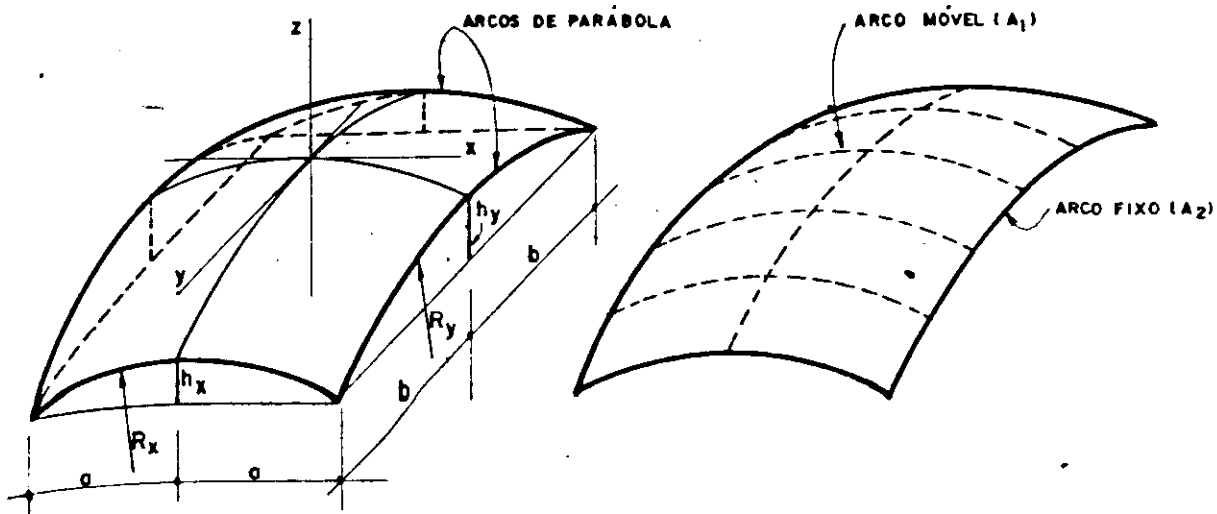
Superfície e geometria do parabolóide elíptico sobre base retangular.
